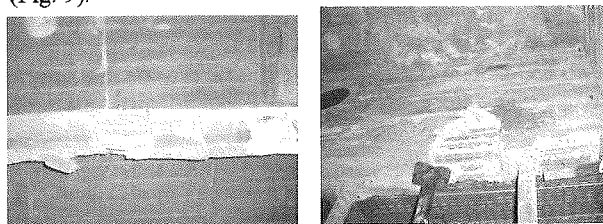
Esempi di danneggiamenti alle strutture in mezzeria delle travi, impalcato del 27° piano e 26° piano
